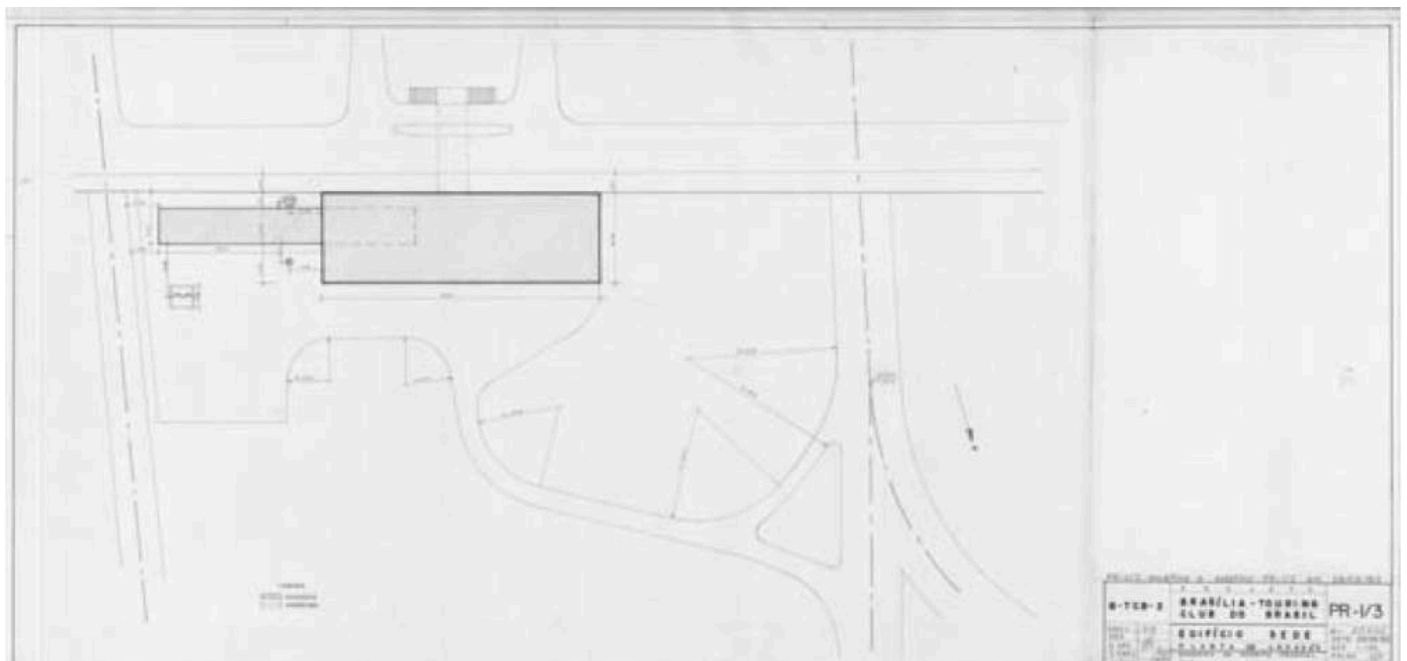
Planta de implantação da primeira proposta. Fonte: Revista Módulo, 1962.
